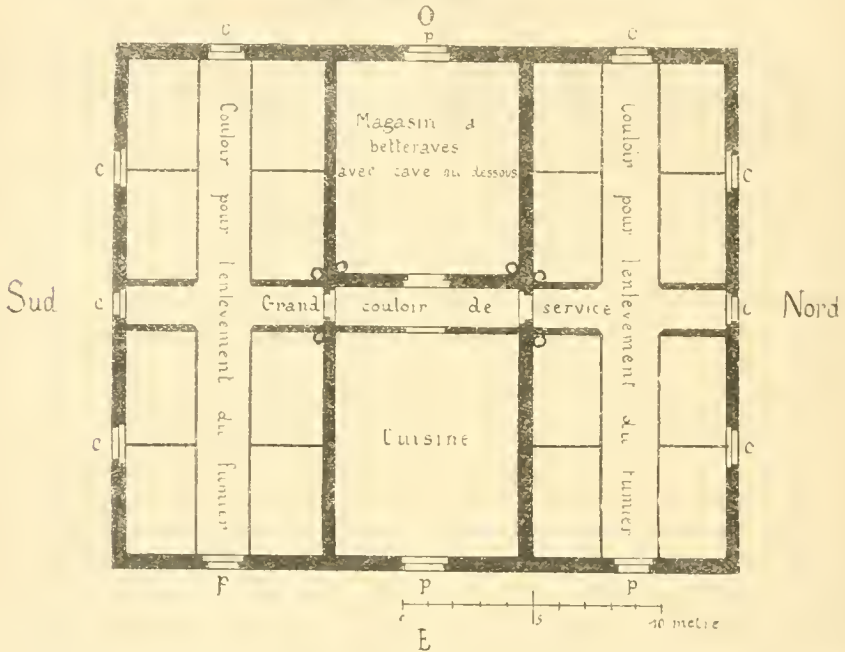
Coupe horizontale au rez-de-chaussée pour montrer le plan d'ensemble (échelle de 10 mètres).
